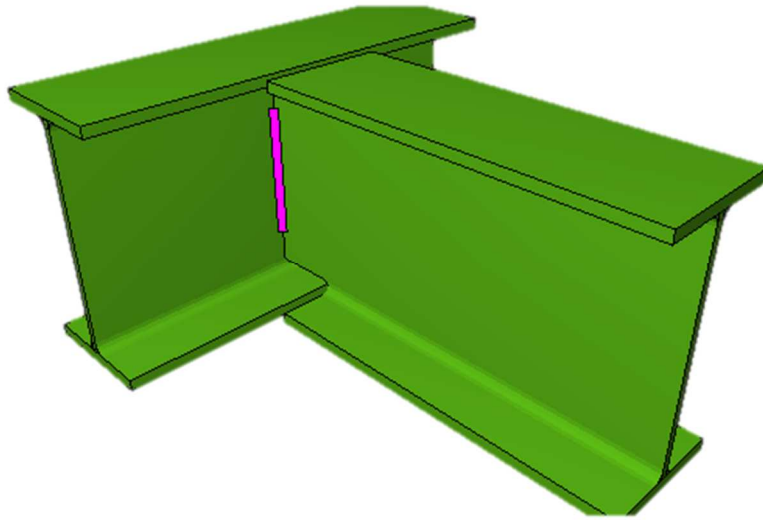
Unión tipo 2 soporte inferior. Viga-viga
